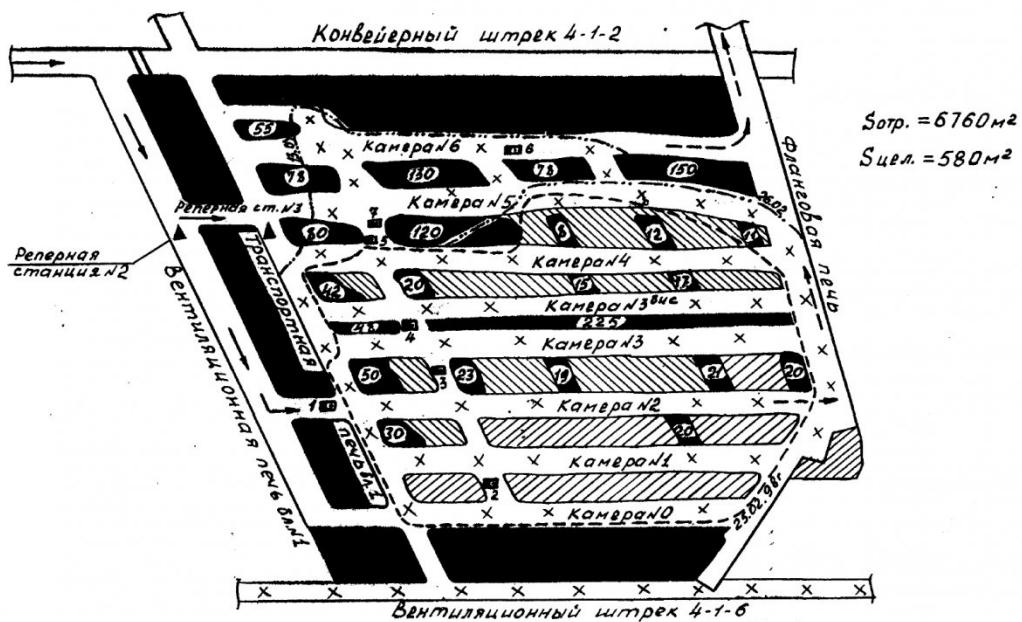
Размещение в выработках блока №1, столб 4-1-4 наблюдательных станций: ▲ – глубинные реперы; ■ – самописец смещения кровли (СПН-22); ----- – контур первичного обрушения кровли; – контур вторичного обрушения кровли; ■■■ – целик угля; //// – отработанные столбы; XX – погашенные выработки
